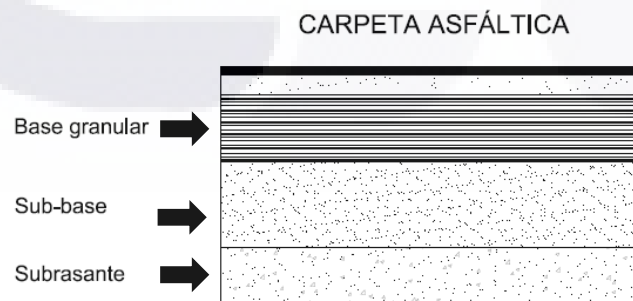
Capas de pavimento asfáltico. Fuente: Bonett, (2014, p. 6).
